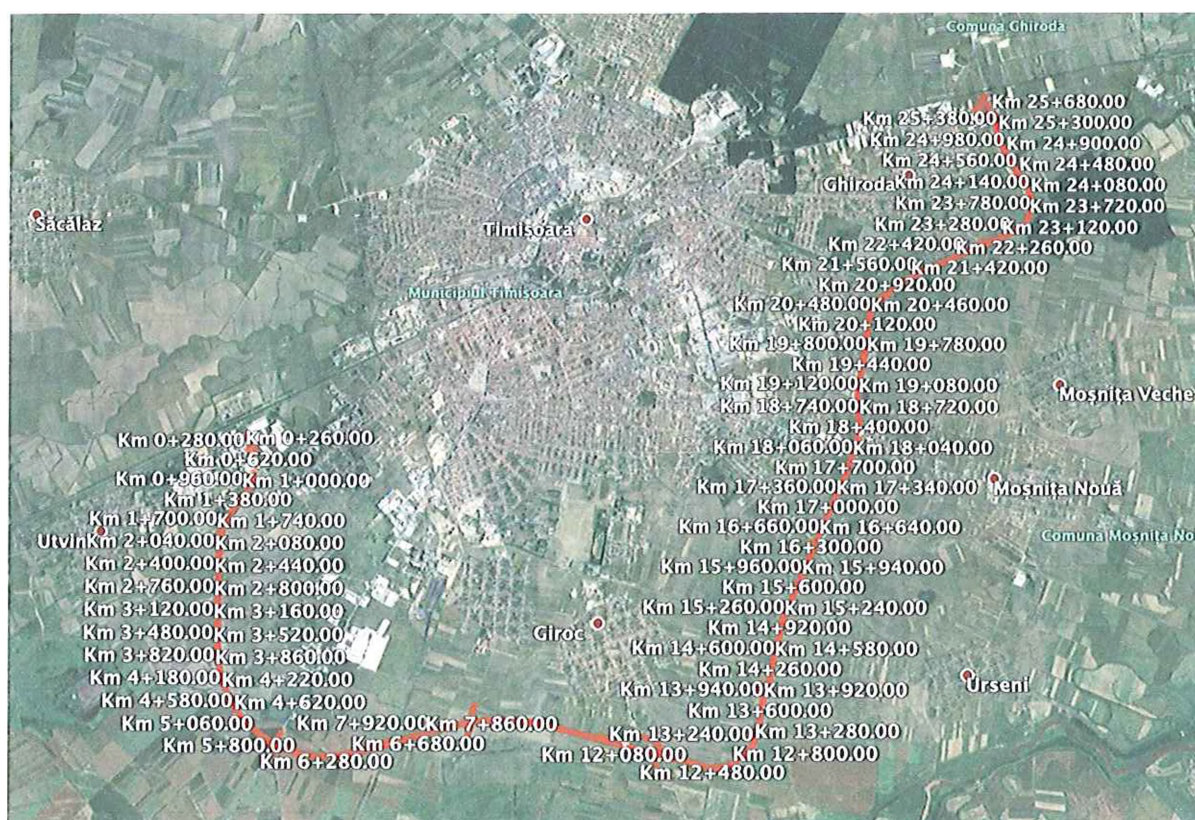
Plan general Varianta Ocolire Timișoara Sud
